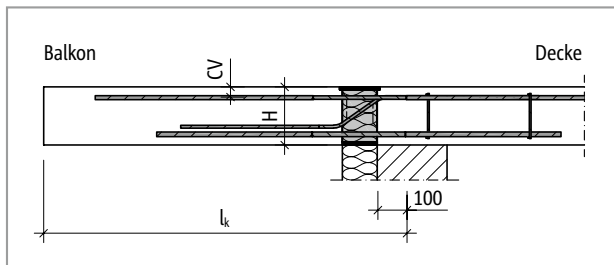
Schöck Isokorb® XT Typ K-M12 bis M13: Statisches System
